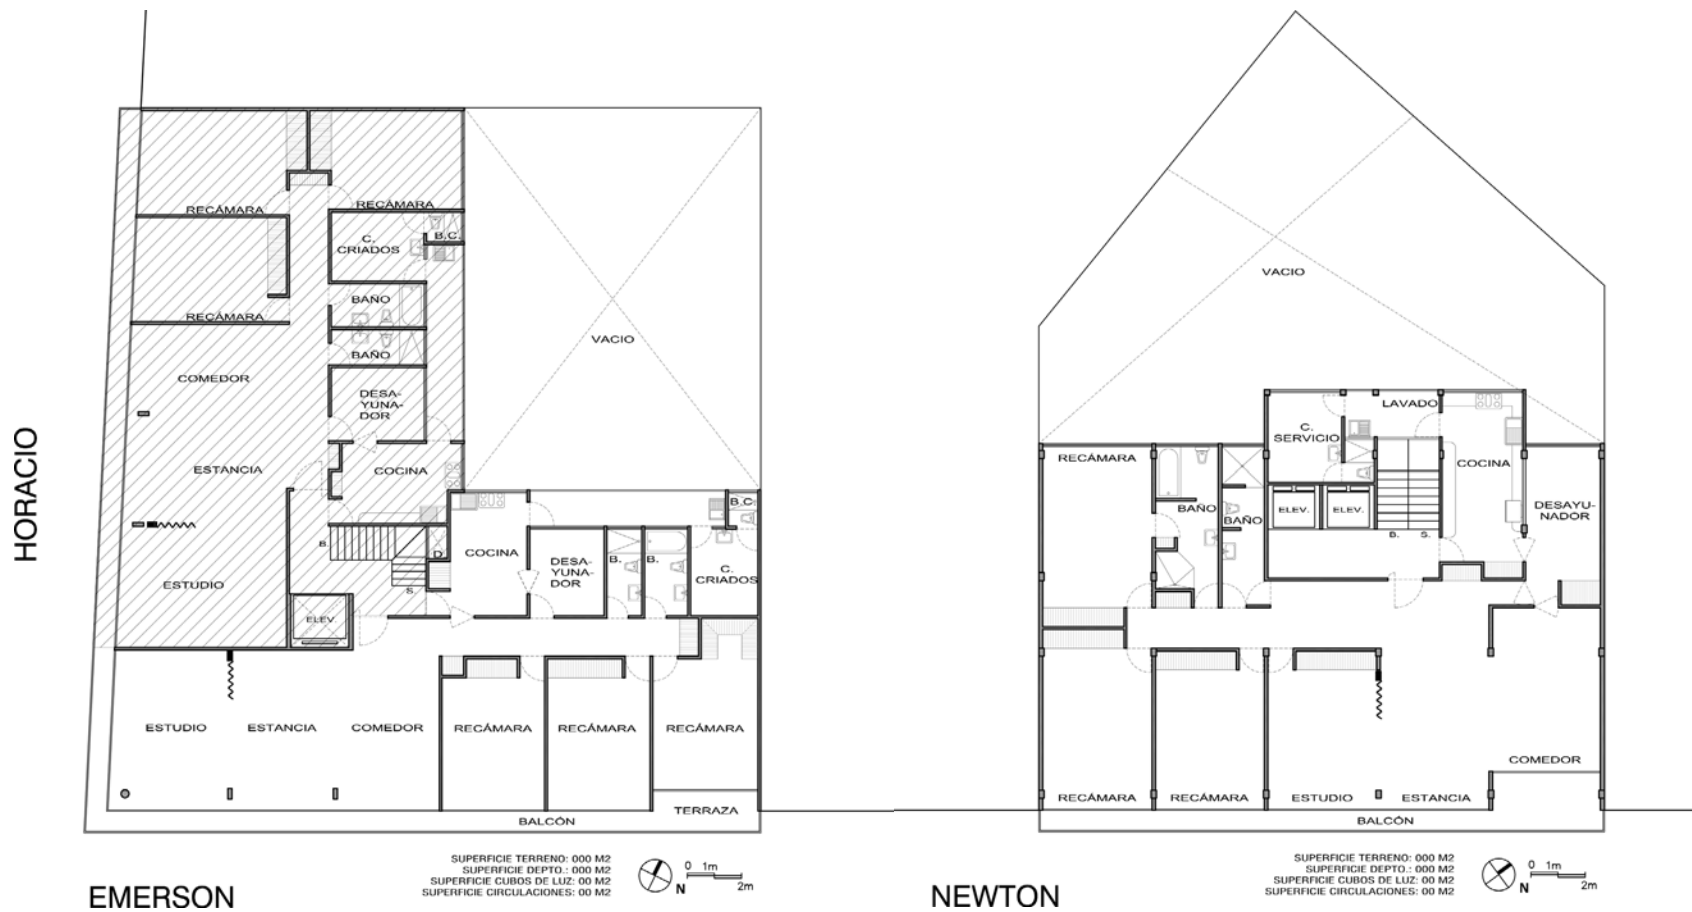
Plantas tipo de Emerson 251 y Newton 156, dibujo Alejandro Leal.
